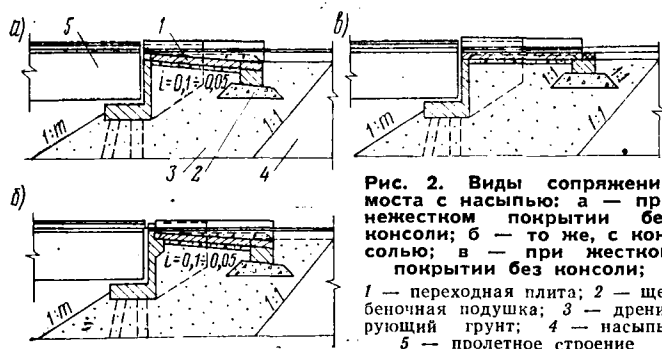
Виды сопряжений моста с насыпью: а — при нежестком покрытии без консоли; б — то же, с консолью; в — при жестком покрытии без консоли; 1 — переходная плита; 2 — щебеночная подушка; 3 — дренирующий грунт; 4 — насыпь; 5 — пролетное строение
